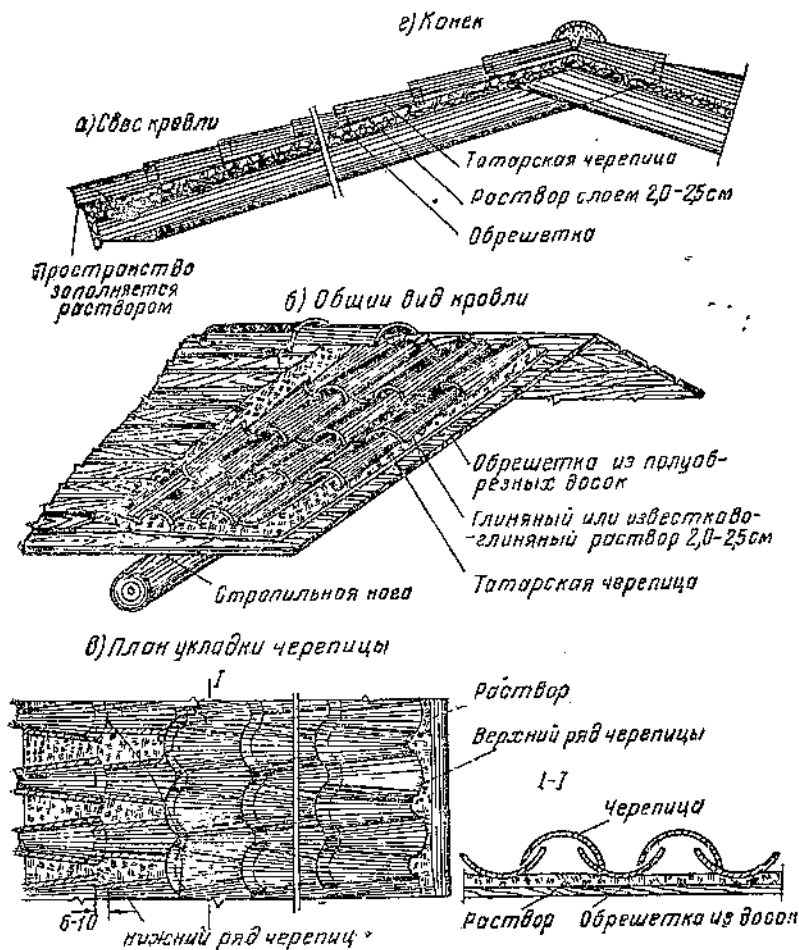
Покрытие кровли татарской желобчатой черепицей.
